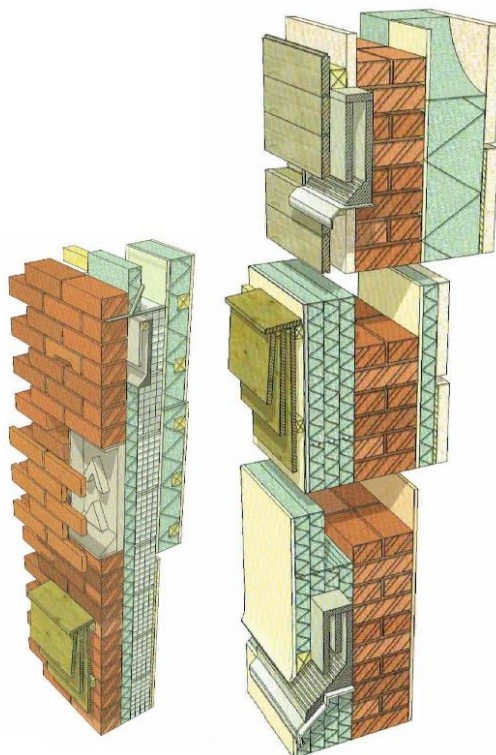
Gîtes pour pipistrelles intégrés dans la façade © Designing for Biodiversity: A technical guide for new and existing buildings Bat Conservation Trust (2013)
